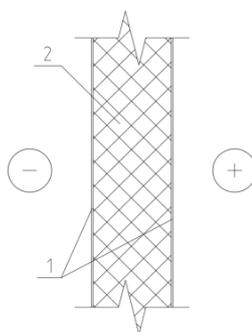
Эскиз наружной ограждающей конструкции стен
